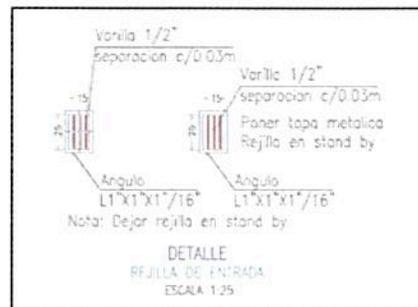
Detalle diseño Rejilla de captación (Datum. 2021).
